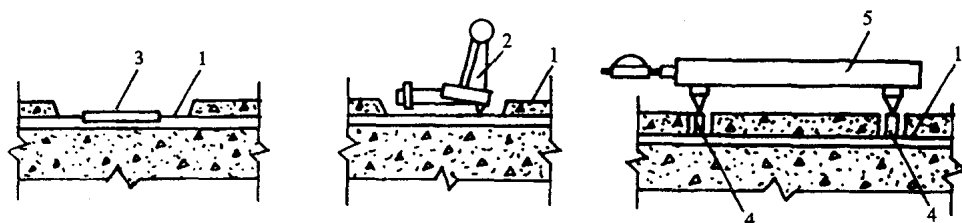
测定钢筋混凝土构件内钢筋应变的方法图示
